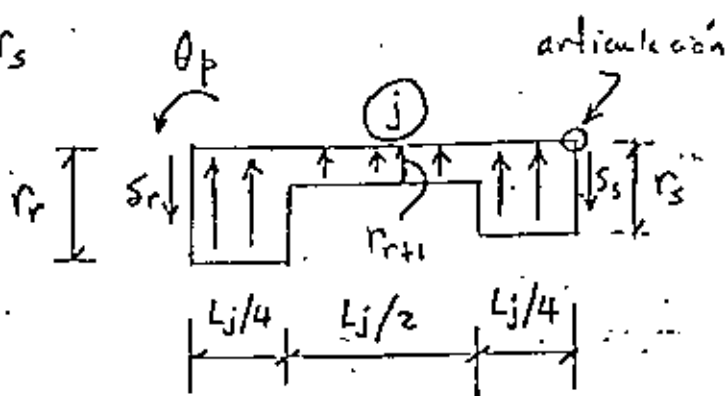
Barra con cargas repartidas en la cimentación. Apoyo continuo a la izquierda y apoyo articulado a la derecha.
